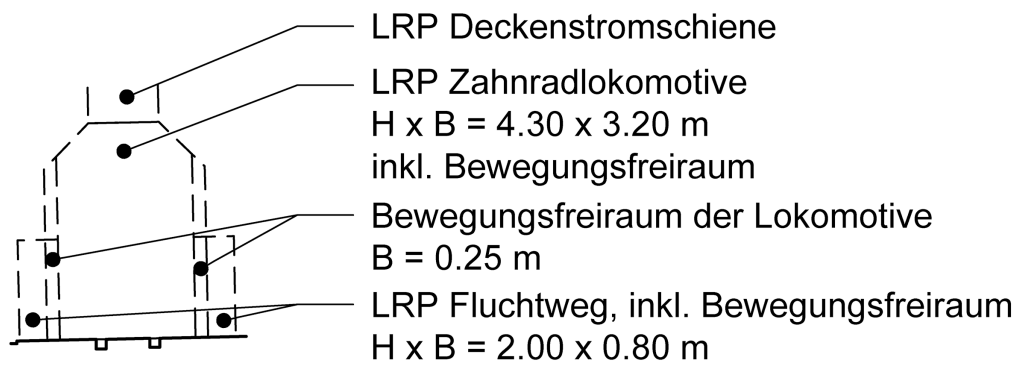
LRP des Zugangstunnels ab dem Zwilag-Areal
